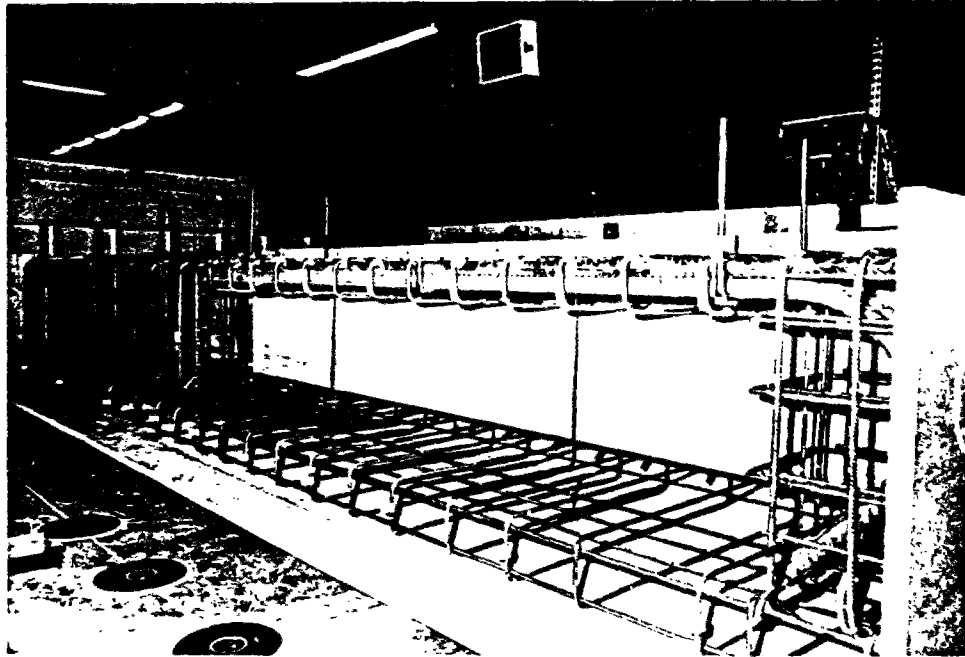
Ferrailage commun aux cinq poutres.
